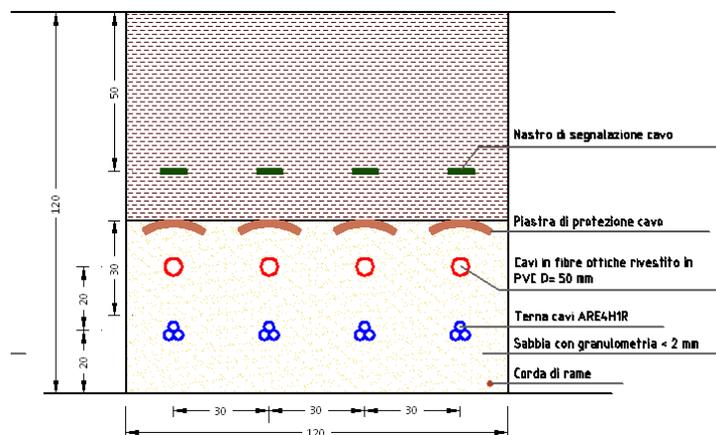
SEZIONE TIPO CAVIDOTTO MT ESTERNO
